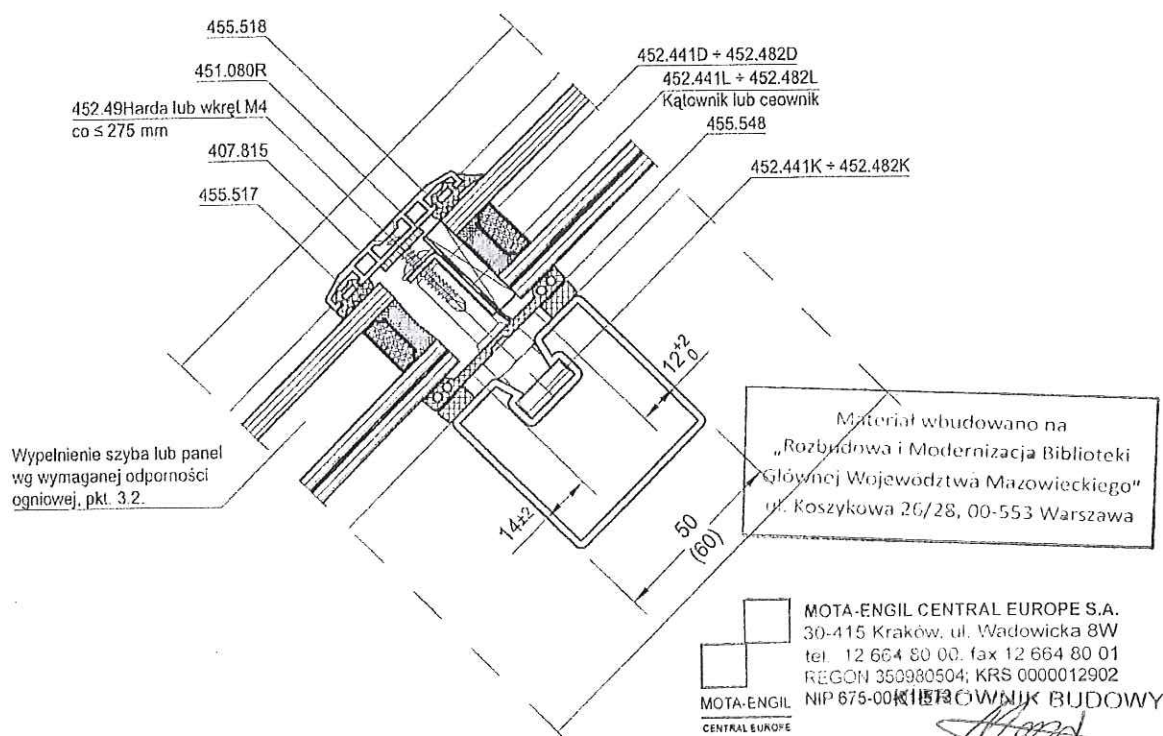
Przykładowe schematy przekryć systemów VISS® Fire TVS Dach, VISS® Fire TV Dach i VISS® Fire DVS Dach
